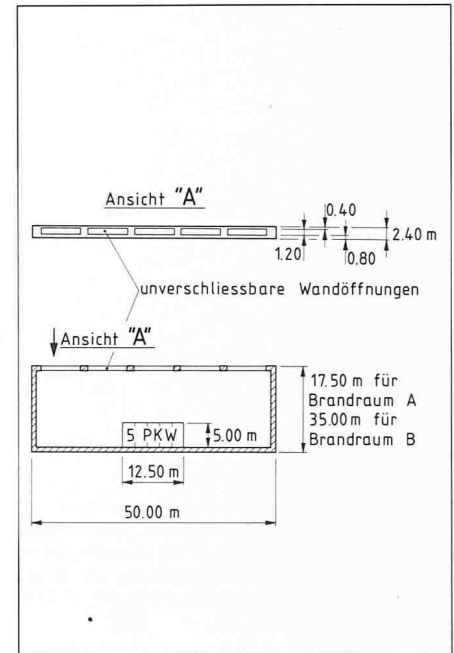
Grundriss und Seitenansicht der Einstellhalle mit unverschlussbaren Seitenöffnungen in einer Seitenwand
